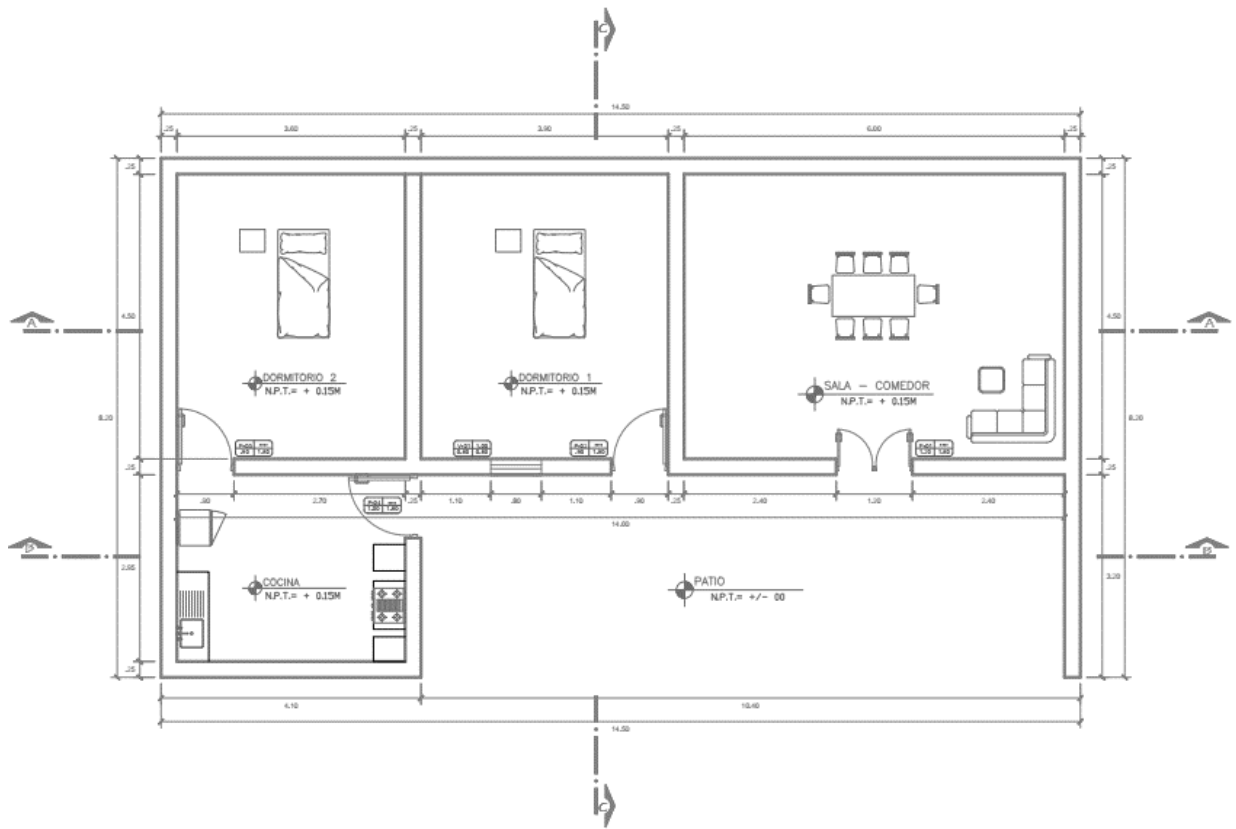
Vista de planta de vivienda. Ver anexo 3.
